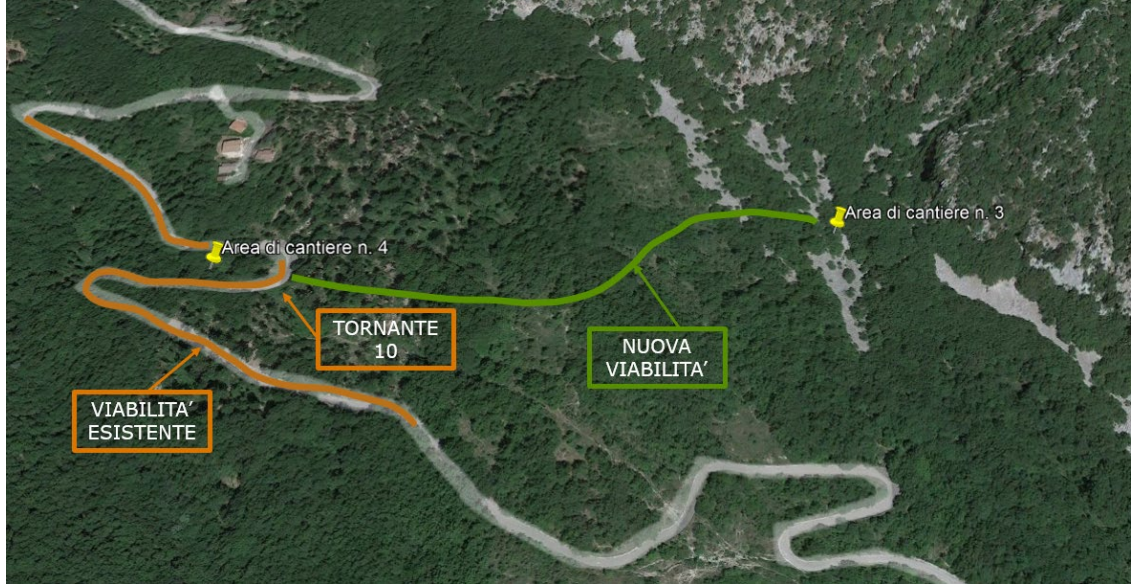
Viabilità di accesso alle aree di cantiere n. 3 e n. 4
